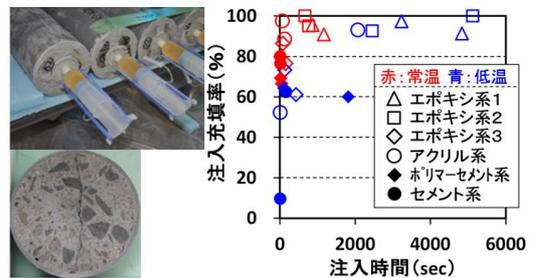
施工時低温環境とひび割れ注入充填性に関する検討
